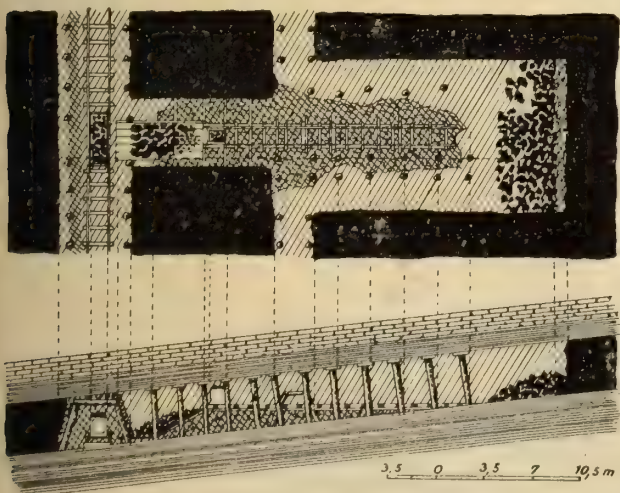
Kammer- und Pfeilerbau mit Abbauförderung durch Füllwagen.
